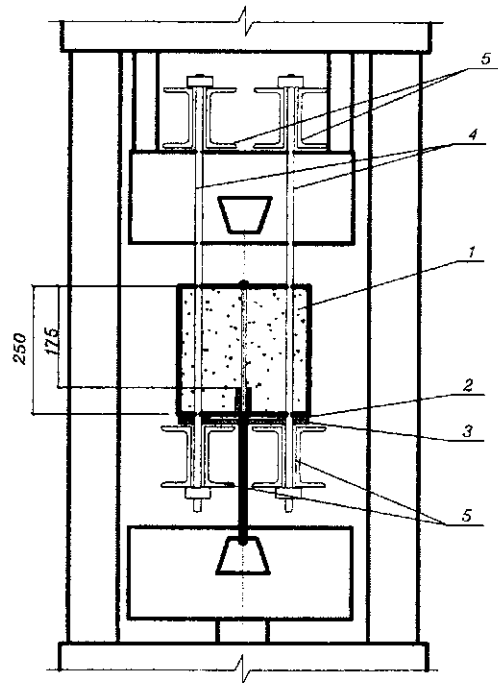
Схема установки для испытания на вытягивание арматурных стержней из бетонных цилиндров:
